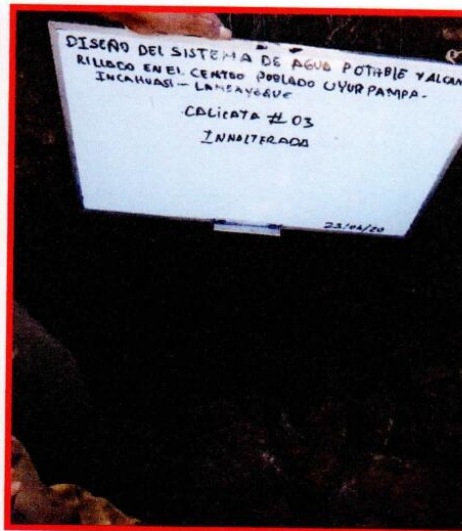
Detalle y registro del perfil del suelo en calicata C-3, notese la presencia de boloneria Ø 6".
